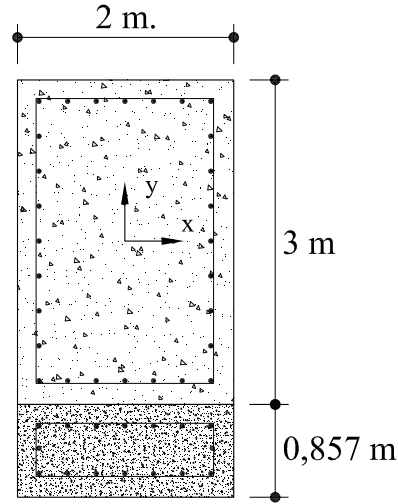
Geometría de la sección de la pila una vez diseñado el refuerzo.
